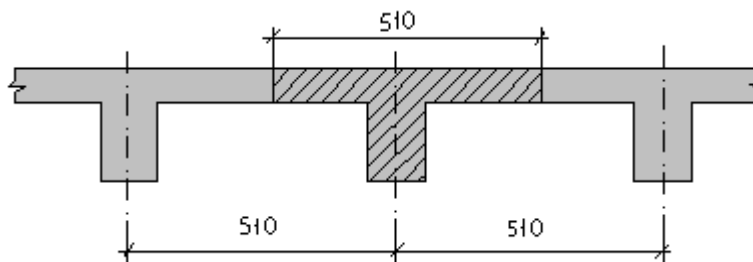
Переріз перекриття у поперечному напрямку
